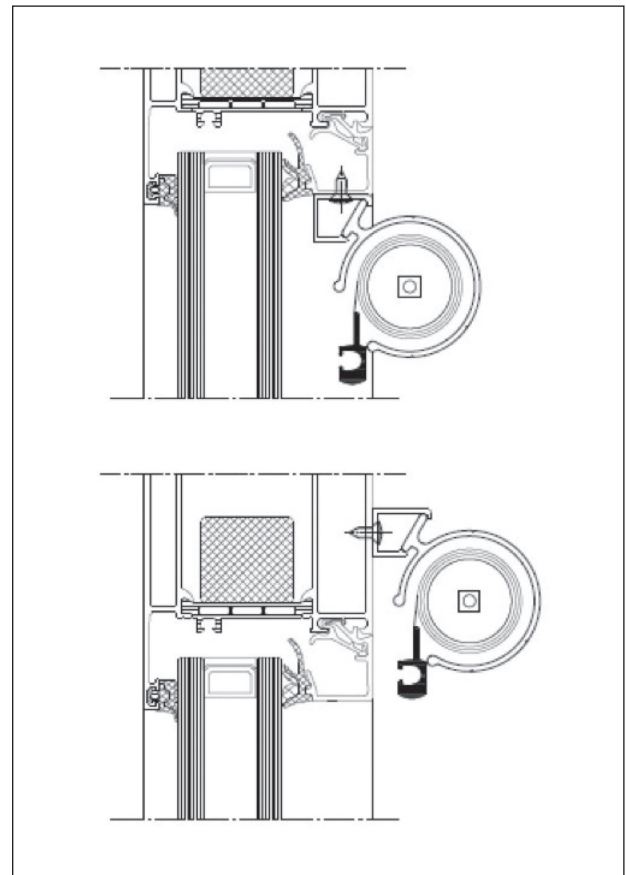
Glasfalzmontage (Einbau mit minimalem Platzbedarf zwischen den Glasleisten) und Rahmenmontage (Einbau auf dem Fensterrahmen mit runder Kassetten) (Ansicht beispielhaft)
